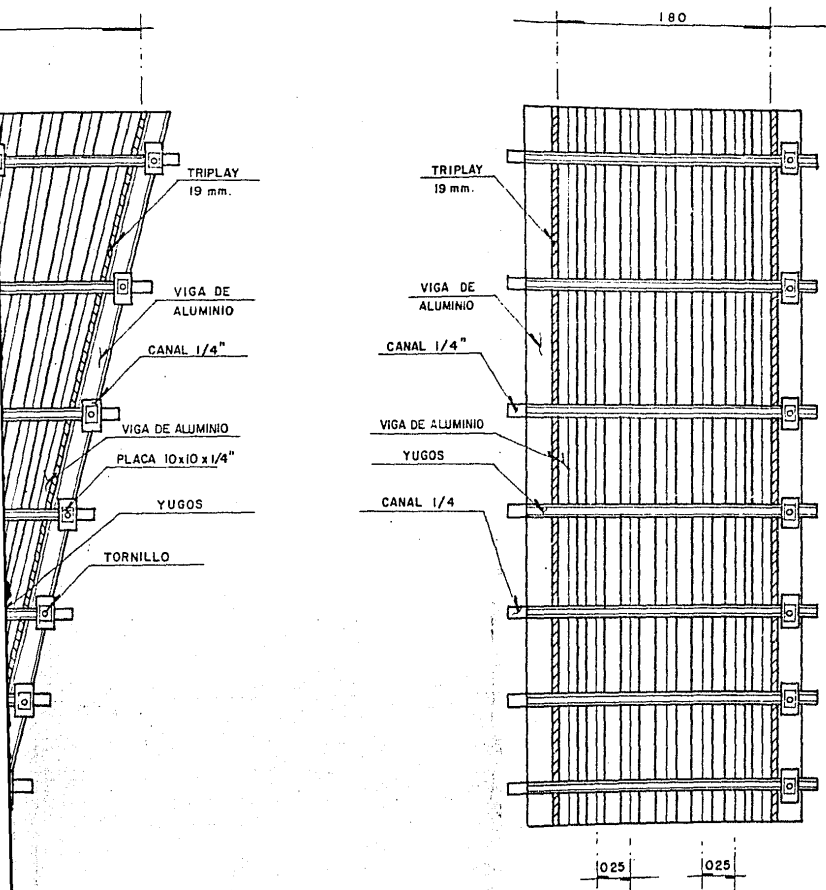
CIMBRA EN COLUMNAS C-27 ; SECC
